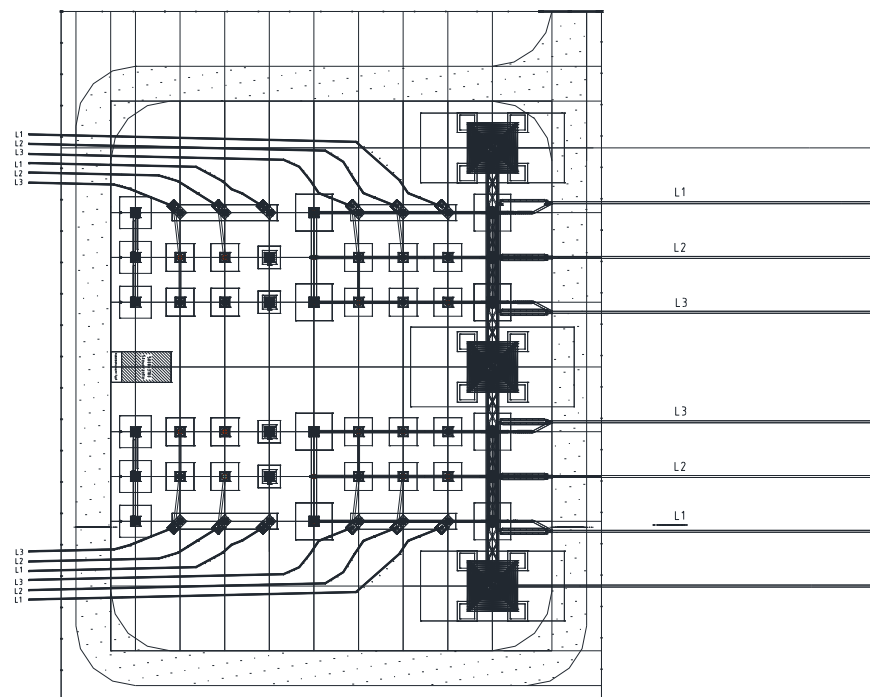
Kabelübergangsanlage, exemplarische Darstellung (Grundriss)
